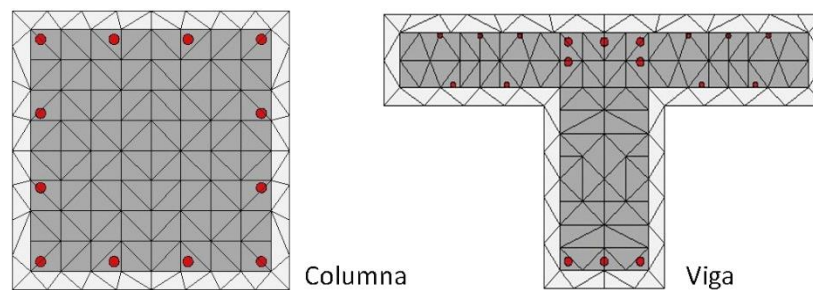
Secciones utilizadas en columnas y vigas con 200 fibras (Seismosoft SRL, 2014)
